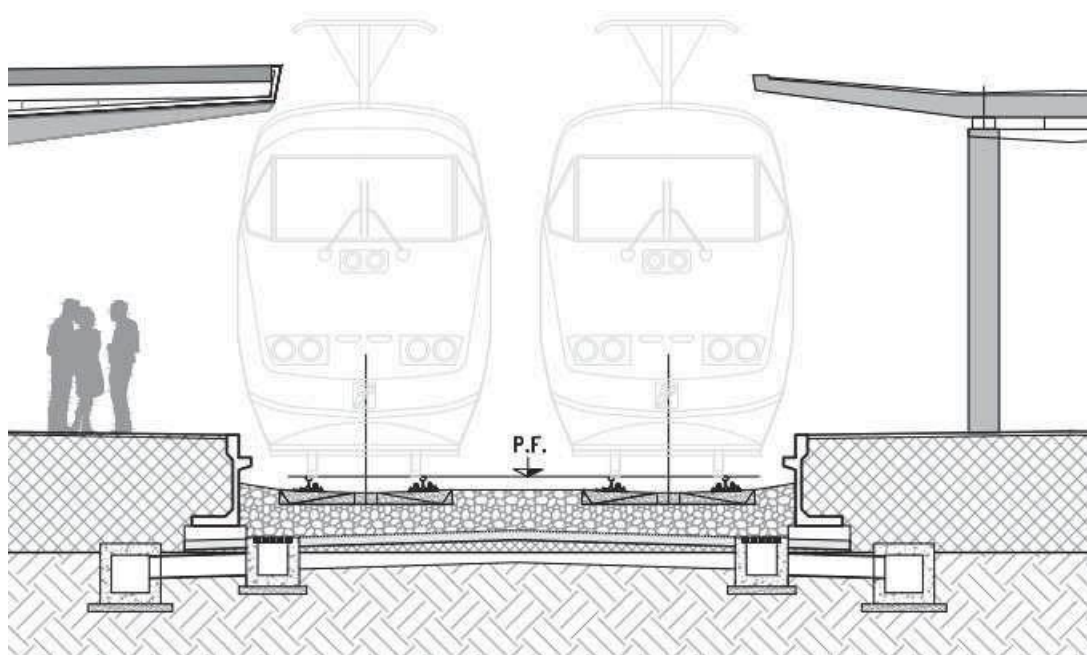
Sezione tipo in corrispondenza delle stazioni
